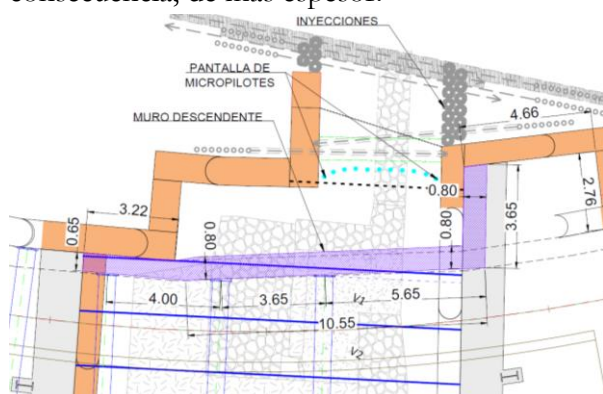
Planta de muro descendente de margen derecha envolviendo el contorno de las pantallas.
